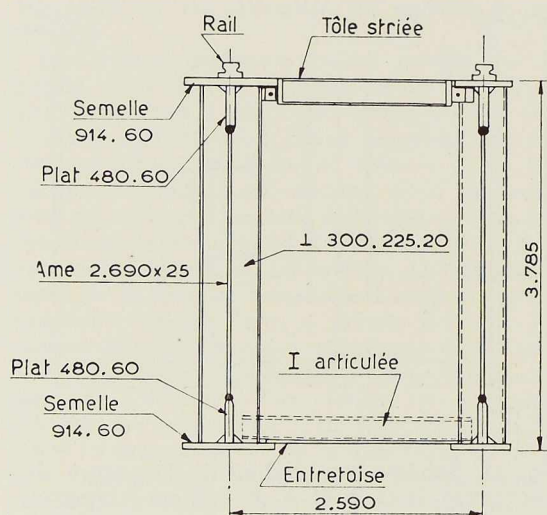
Abbey Works. Section des poutres de roulement de la fonderie. La portée de ces poutres atteint 33<sup>m</sup>60.
